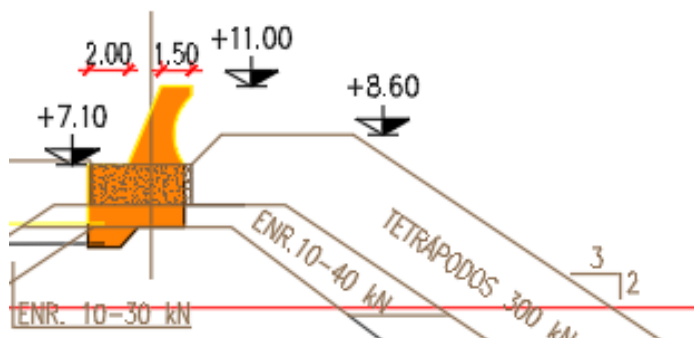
Perfil Transversal do novo muro-cortina – Cenário 1
